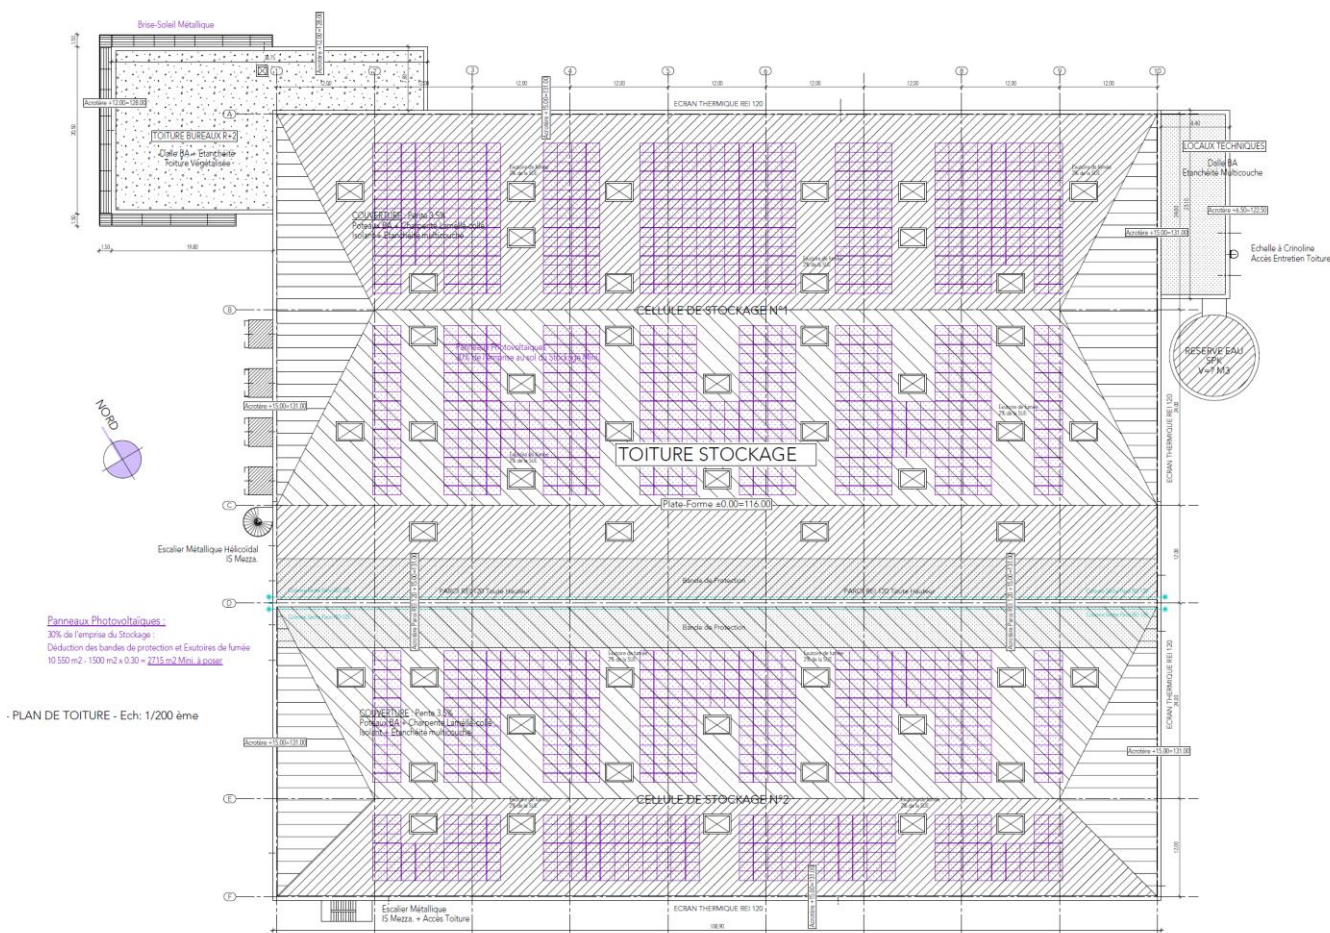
Plan d'implantation des installations photovoltaïques en toiture
